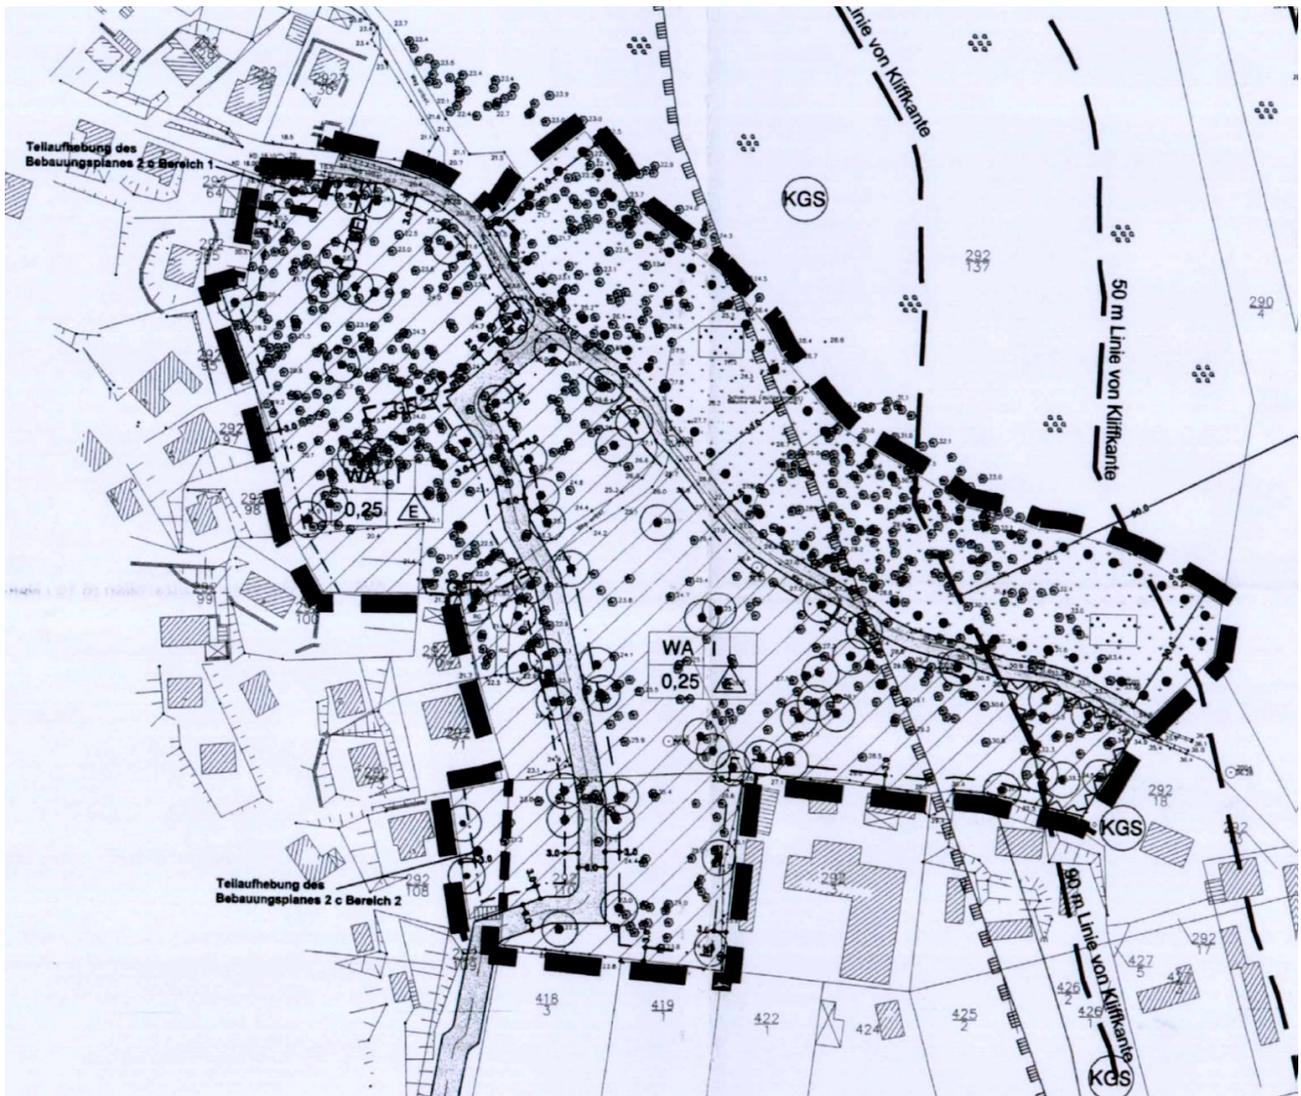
Planzeichnung Ursprungsplan, ohne Maßstab
